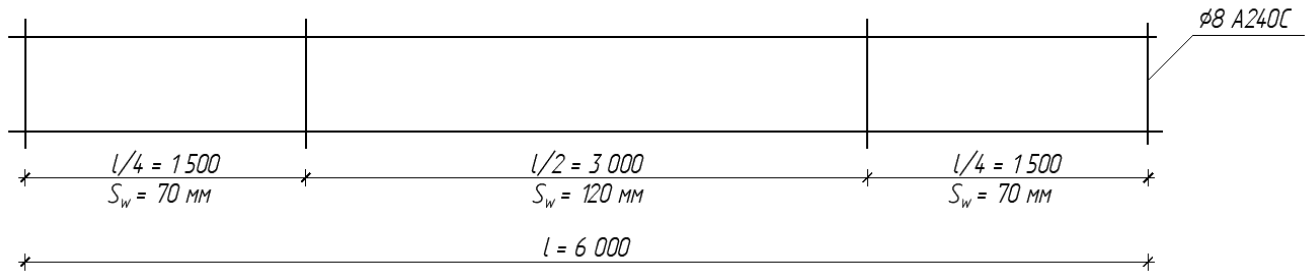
Схема розташування поперечної арматури по довжині балки
